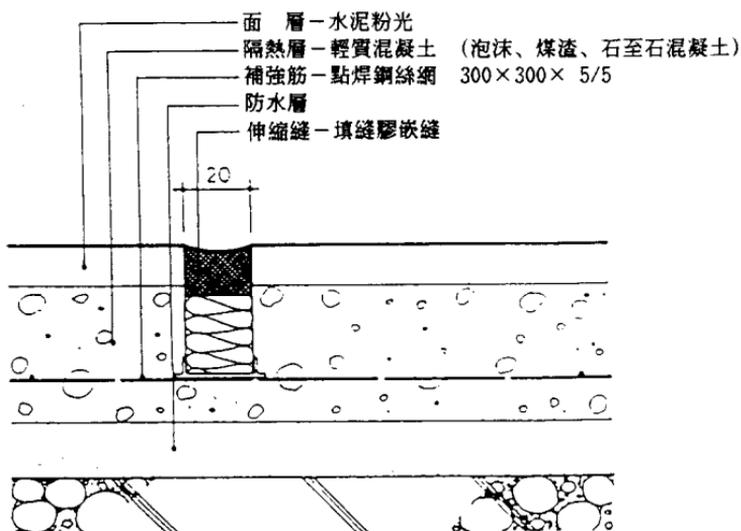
泡沫、煤渣、蛭石混凝土隔熱施工示意圖 [16]
